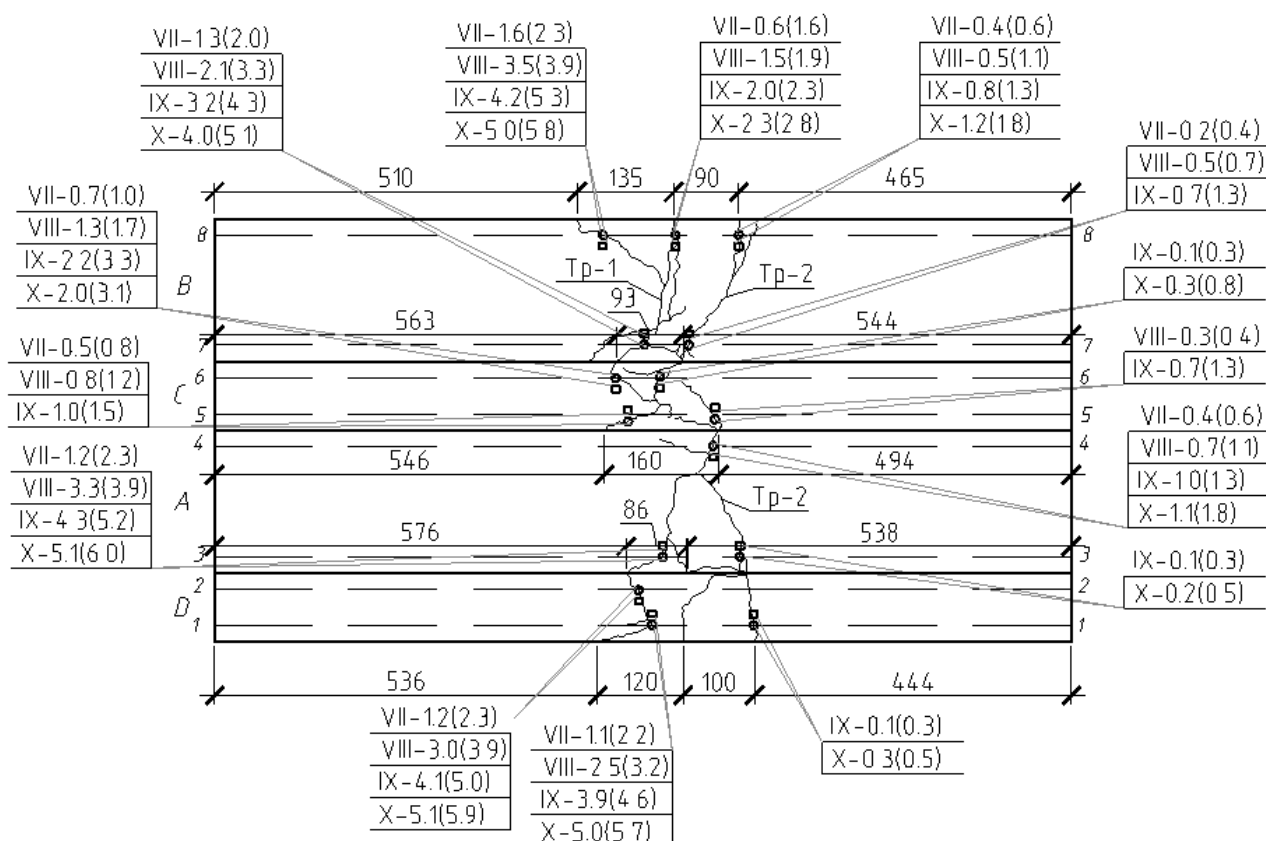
Раскрытие трещин в экспериментальной железобетонной конструкции С2-Б1
